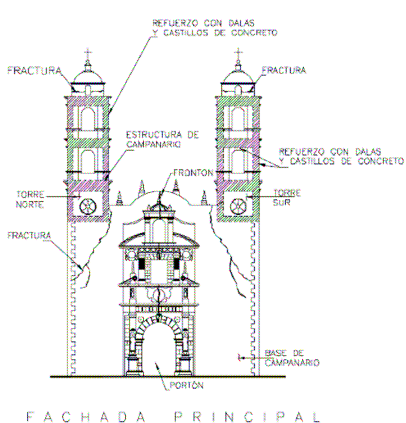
Refuerzo de torres de campanario con hormigón armado. (De la Torre et al., 2004).
